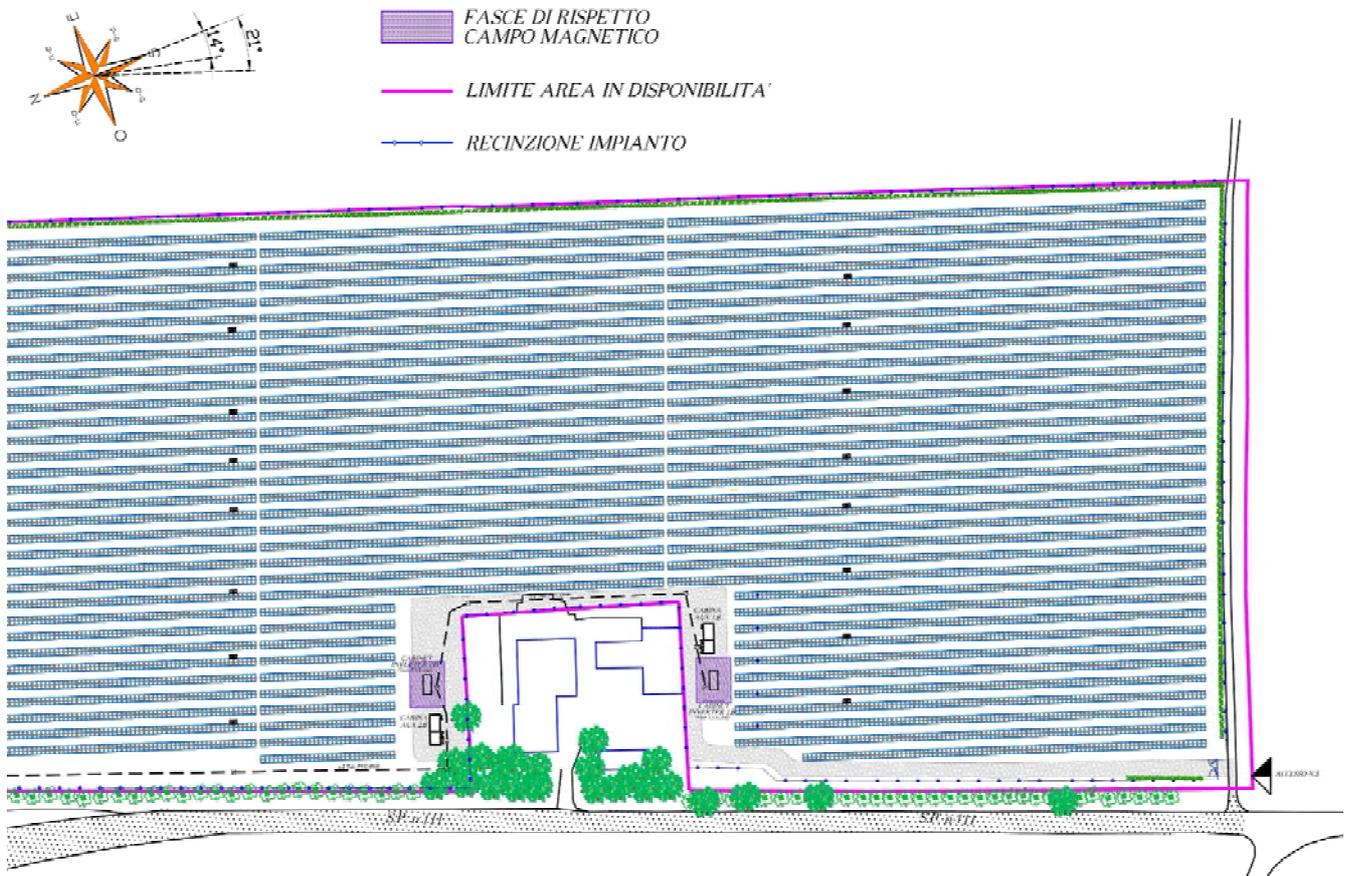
Planimetria individuazione fasce di rispetto determinate - zona sud
